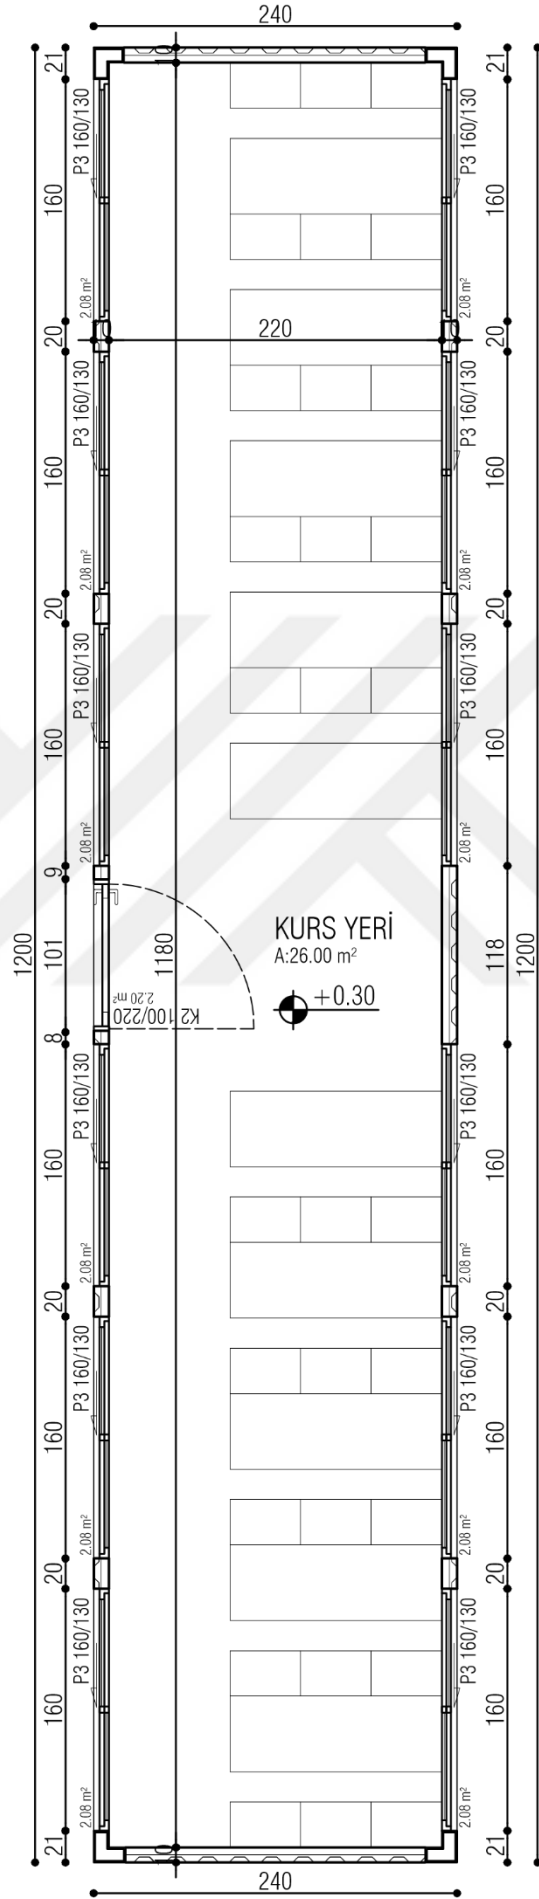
İbadethane Konteyneri Planı (Ölçek : 1/150).
